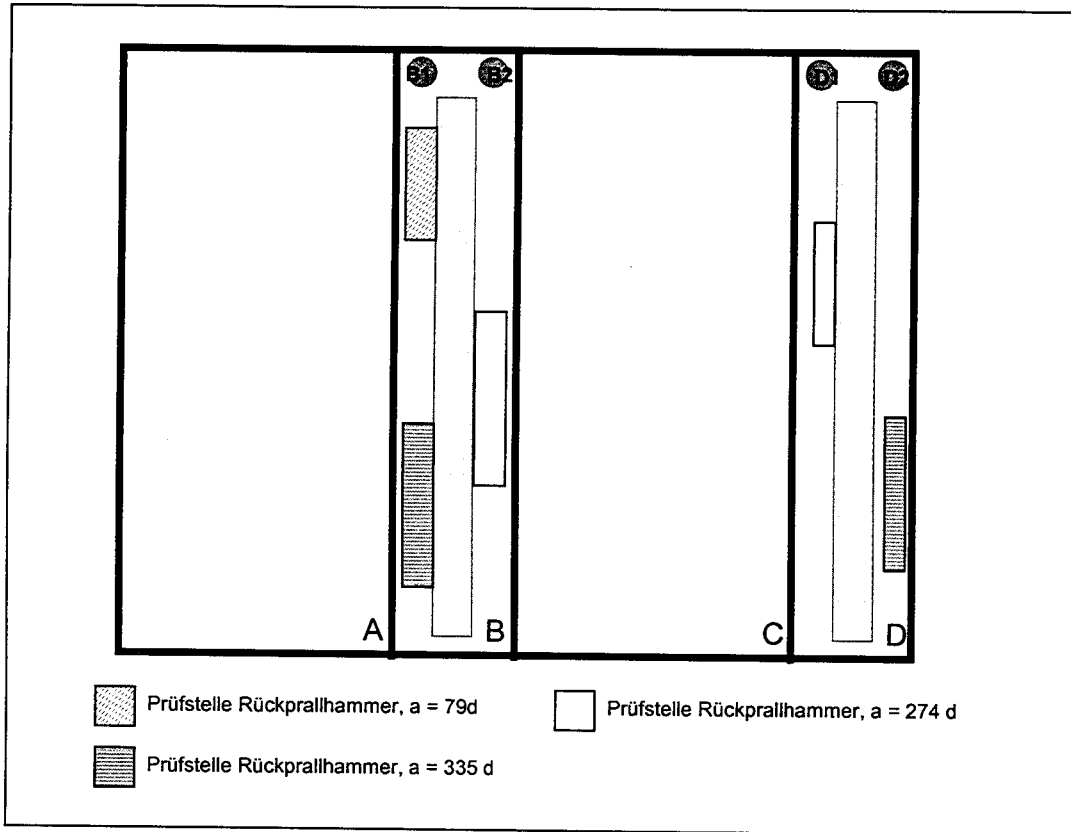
Lage der Prüfflächen am Betonkörper 10
